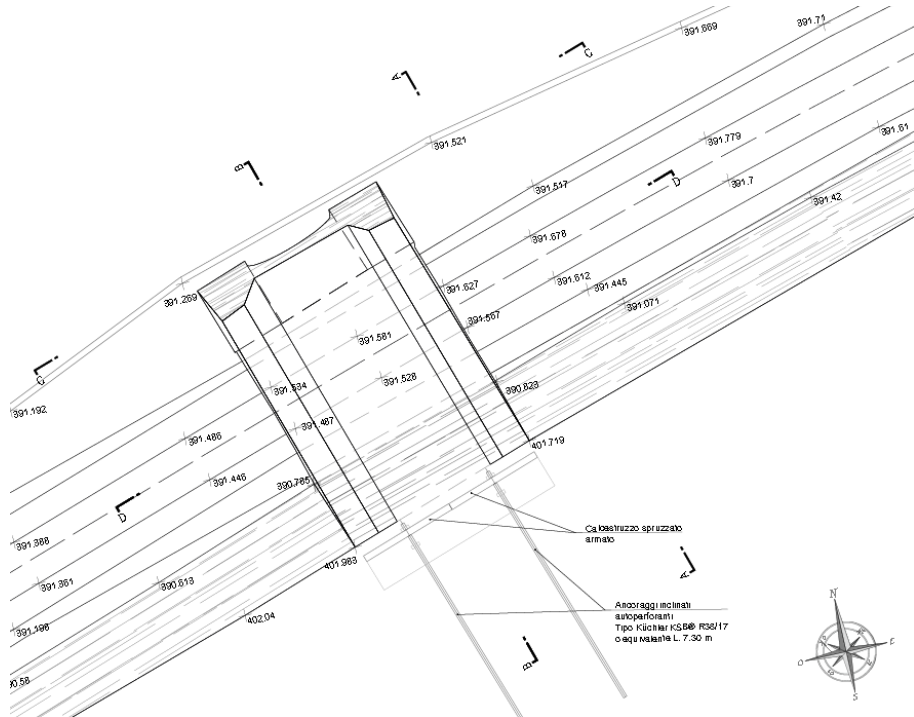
IV02 - Scivolo legnami 134+610 – Planimetria
